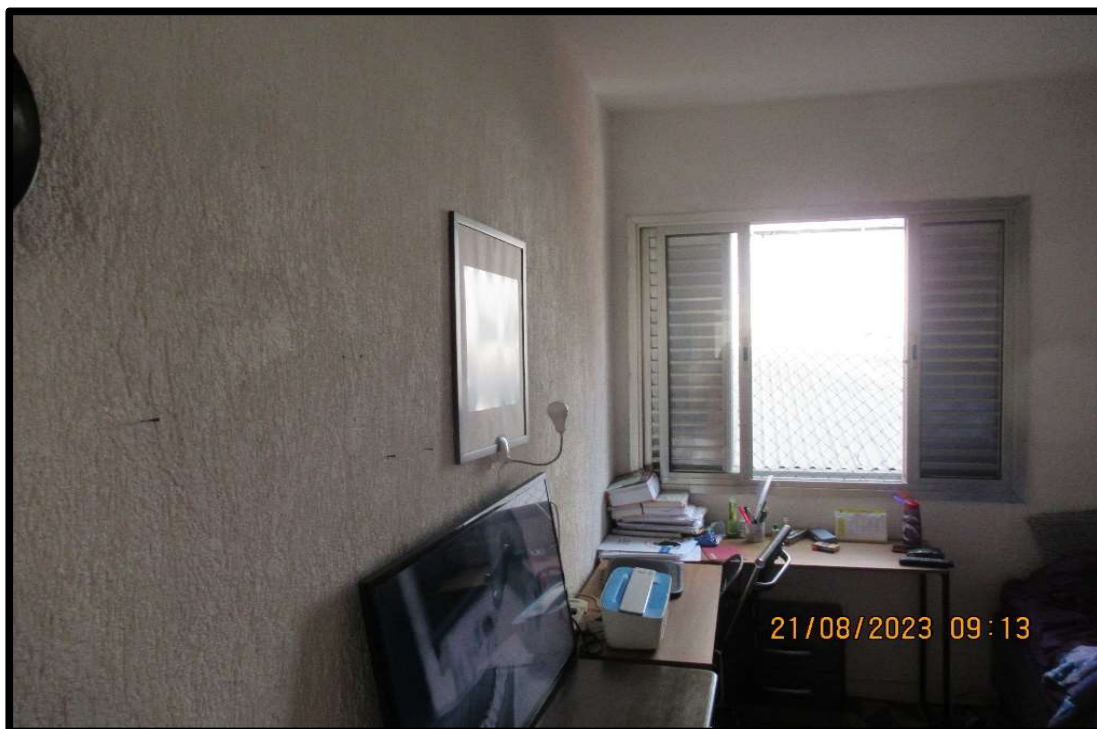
Vista do dormitório. Suas principais características construtivas são: piso em tacos de madeira, paredes texturizadas, forro em laje e esquadrias de alumínio.
